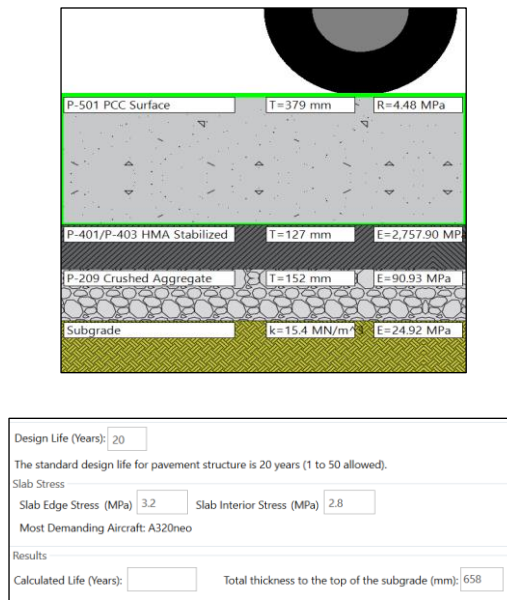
Espesor de losa de concreto calculado para las Calles de Rodaje B y C del Aeropuerto de Iquitos.
